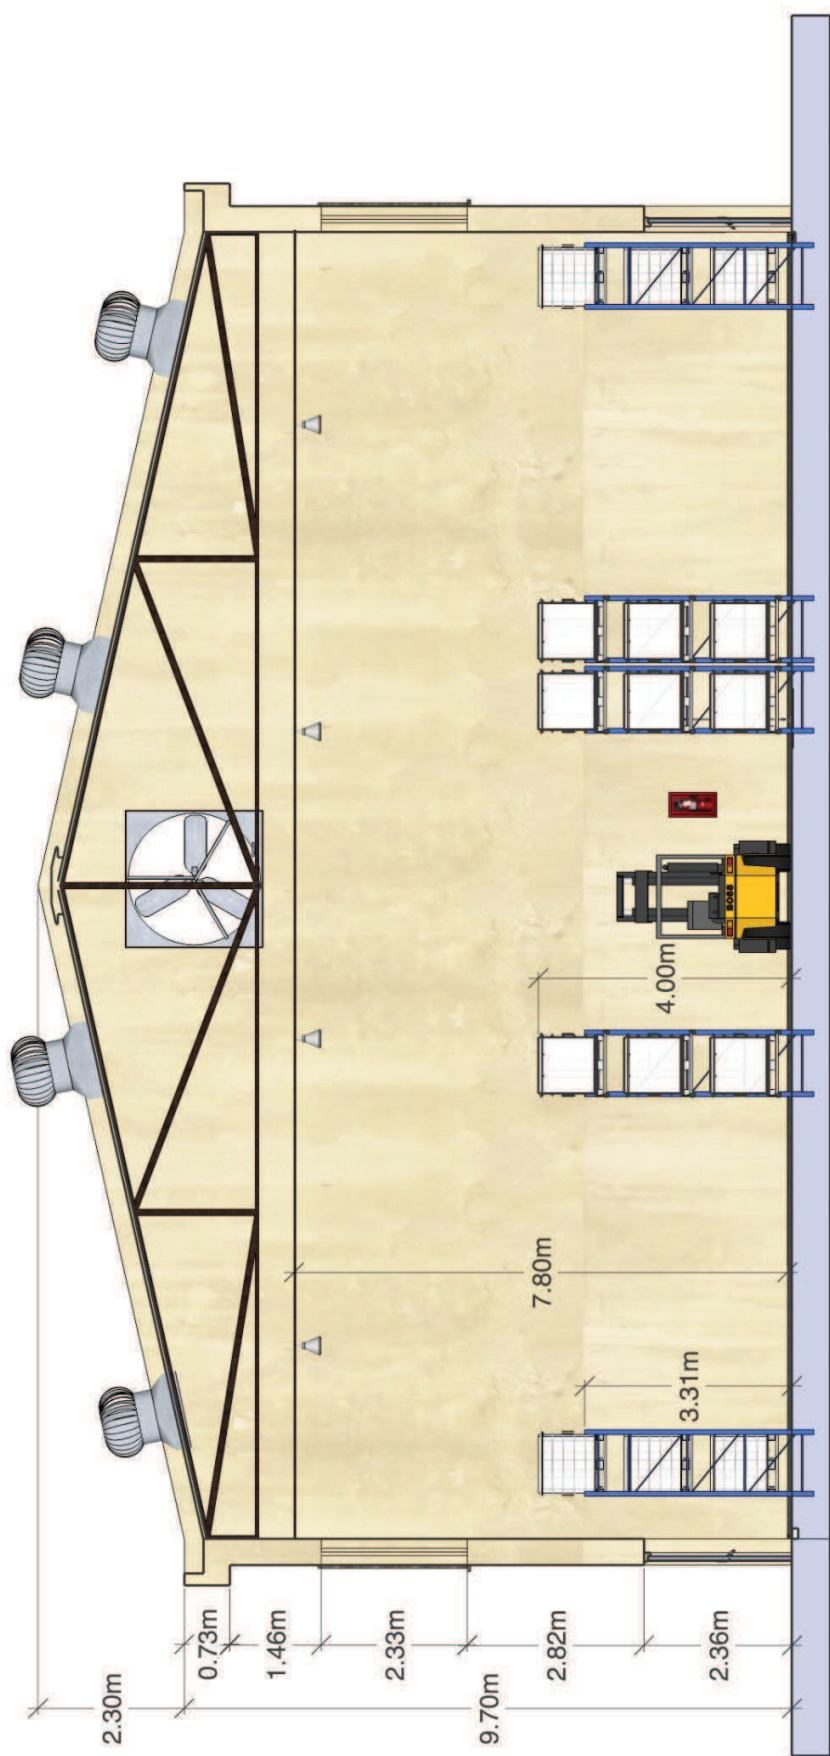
Corte seccional de vista frontal de fachada de bodega de escorias salinas de aluminio secundario.
